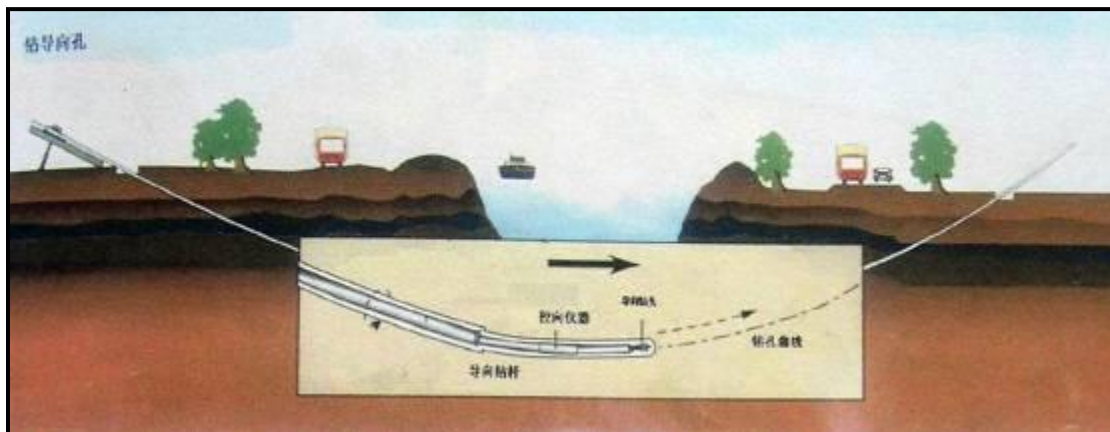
定向钻穿越施工钻导向孔过程断面示意图
